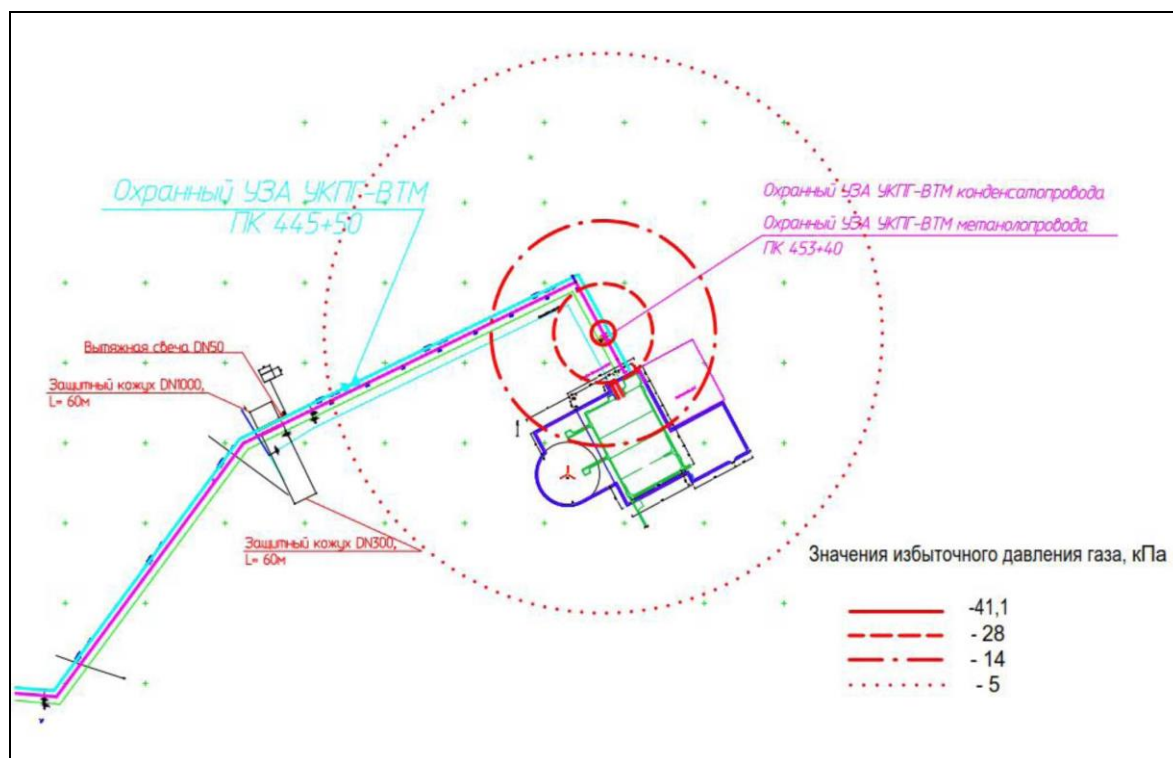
План наиболее опасной аварии на газопроводе в районе ЗСМ
